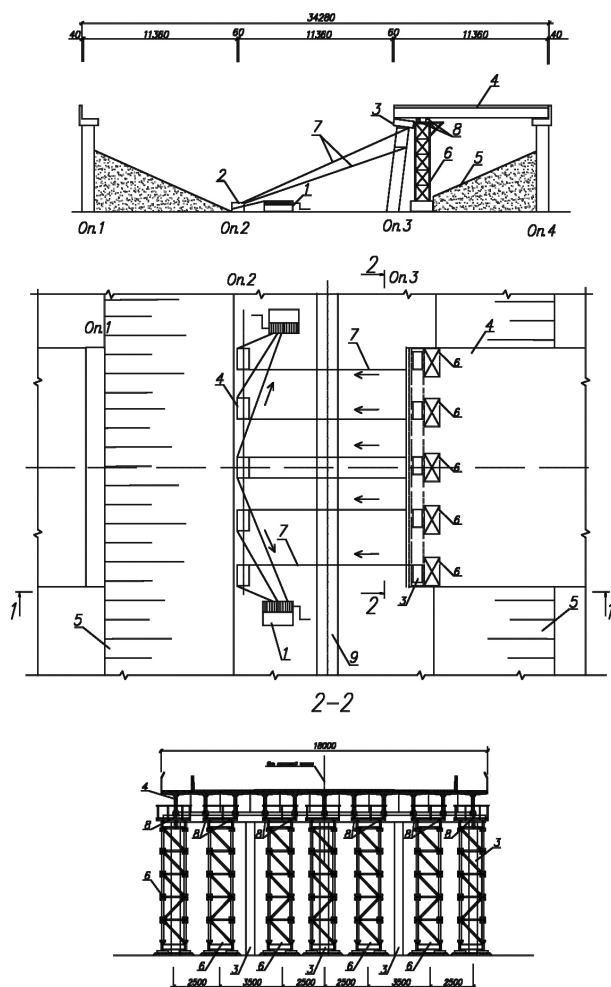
Устранение крена опоры № 3: 1 – лебедка; 2 – оголовок фундамента опоры № 2; 3 – опора № 3, имеющая крен; 4 – балки пролета 3-4; 5 – откосы; 6 – временная опора; 7 – тяговые тросы; 8 – домкраты; 9 – ж/д пути
